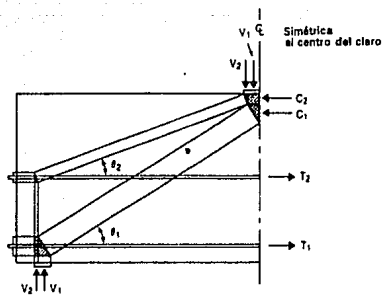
Modelo de la armadura plástica para vigas con retuerzo horizontal en el alma (Ref. 3)
